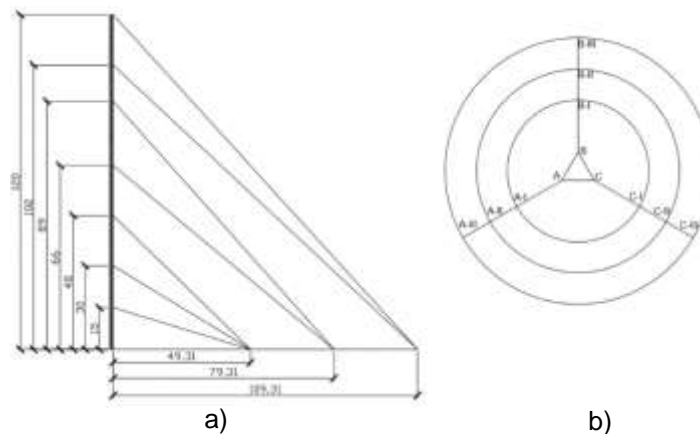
a) Elevación de la torre MAR-181, b) Planta de la estructura del modelo MAR-181
